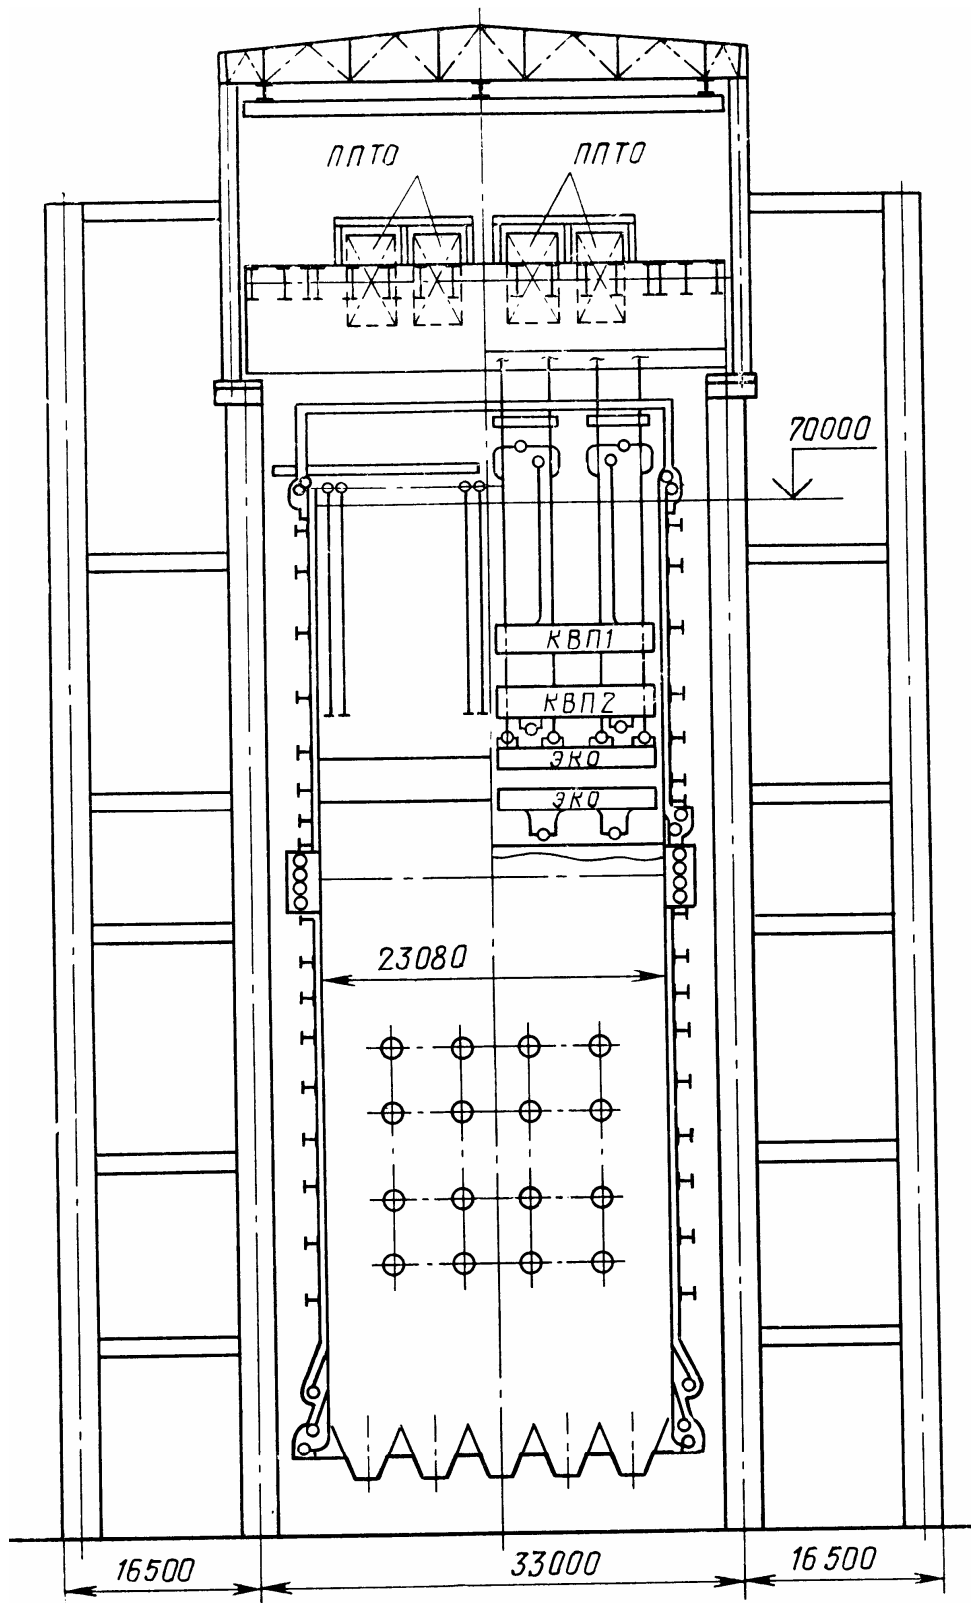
Поперечный разрез котла Пп-1650-25-545 КТ (П-76)
